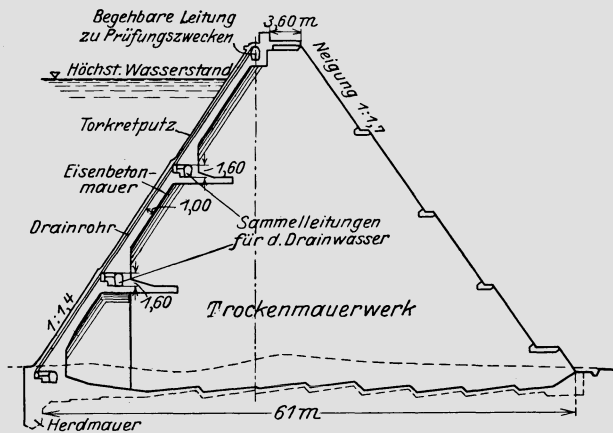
Belice- oder Honedamm, Sizilien. Maßstab 1 : 1000.
